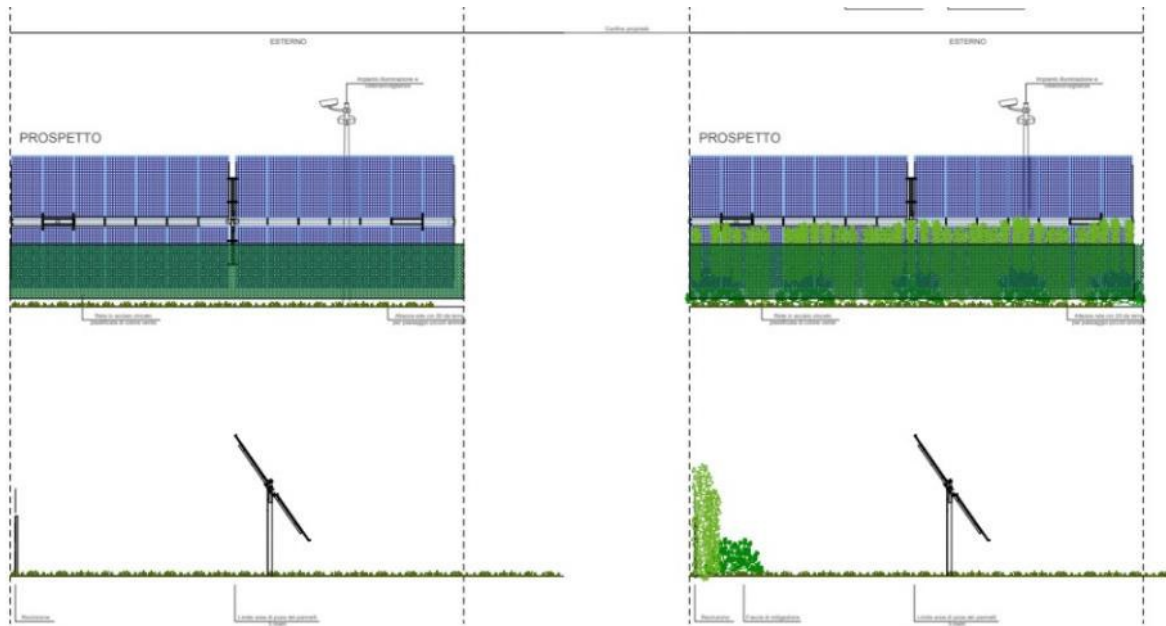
Layout fasce zone perimetrali impianto senza e con fasce di mitigazione.
